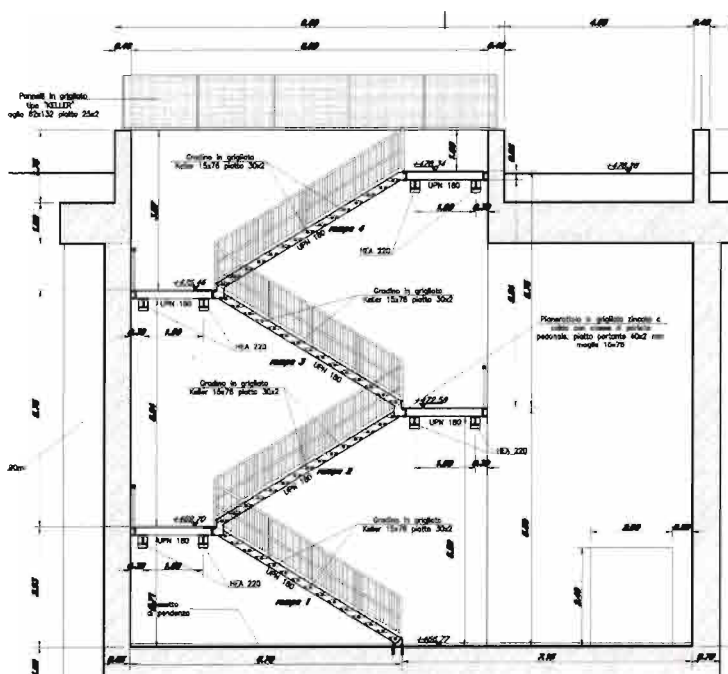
Sezione scala Interconnessione Ponte Gardena
